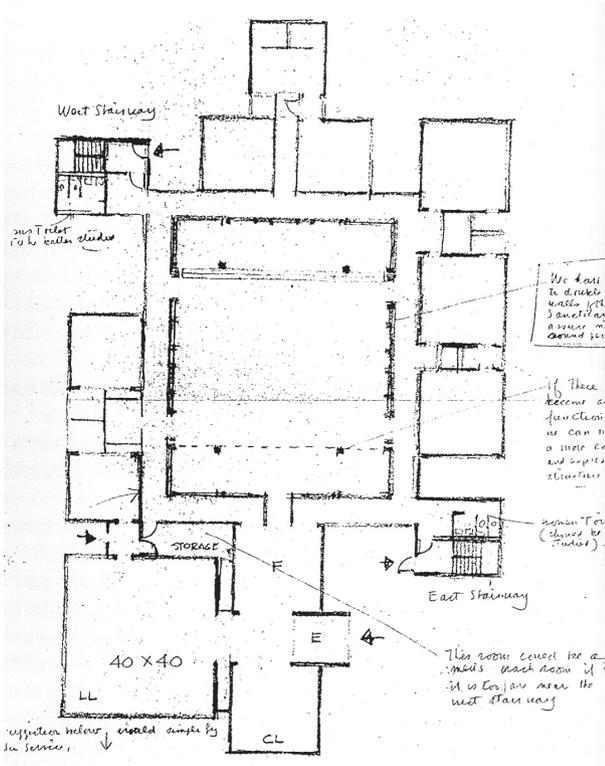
Primeira Igreja Unitária e Escola. Planta (junho, 1961).
